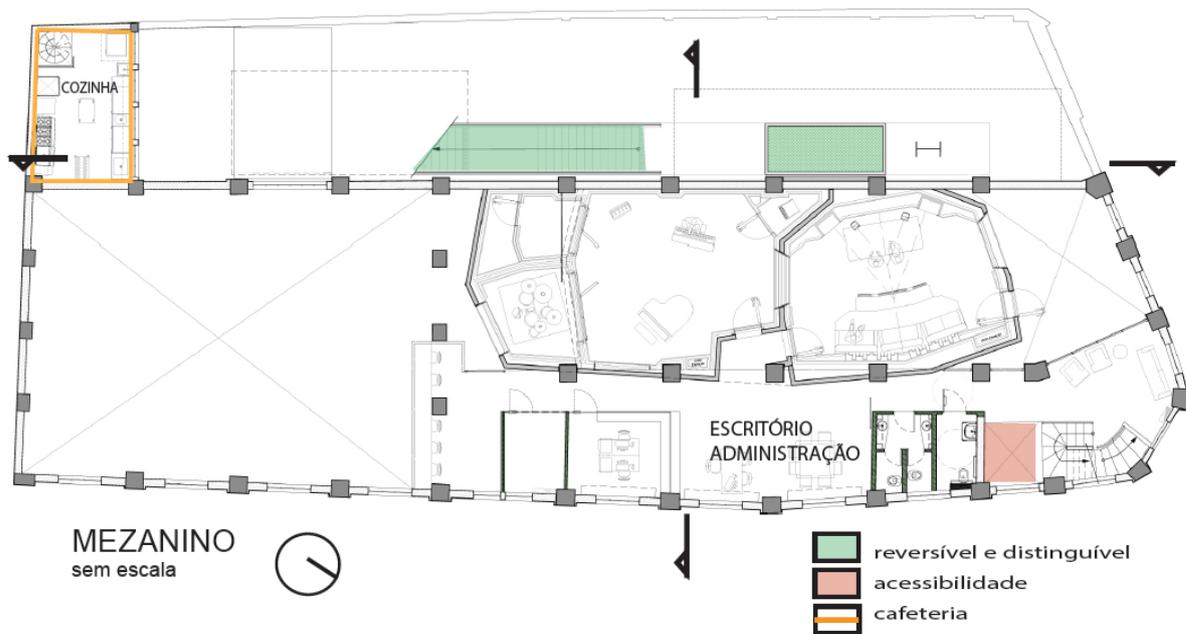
Planta do Mezanino do Centro Cultural *Red Bull Station* (ARCHDAILY, 2013)
